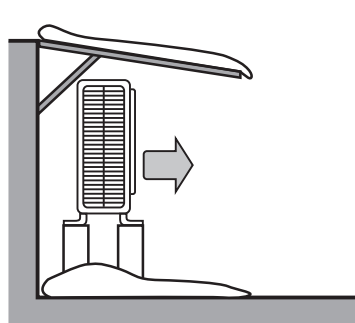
Installazione dell'apparecchio esterno su zoccolo sopraelevato e pensilina di protezione dalla neve
